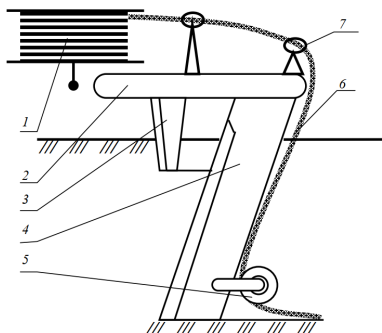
Бестраншейный рабочий орган с черенковым ножом: 1 – барабан; 2 – рама; 3 – дернорез; 4 – черенковый нож; 5 – прижимной ролик; 6 – дренажная труба; 7 – направляющее кольцо
